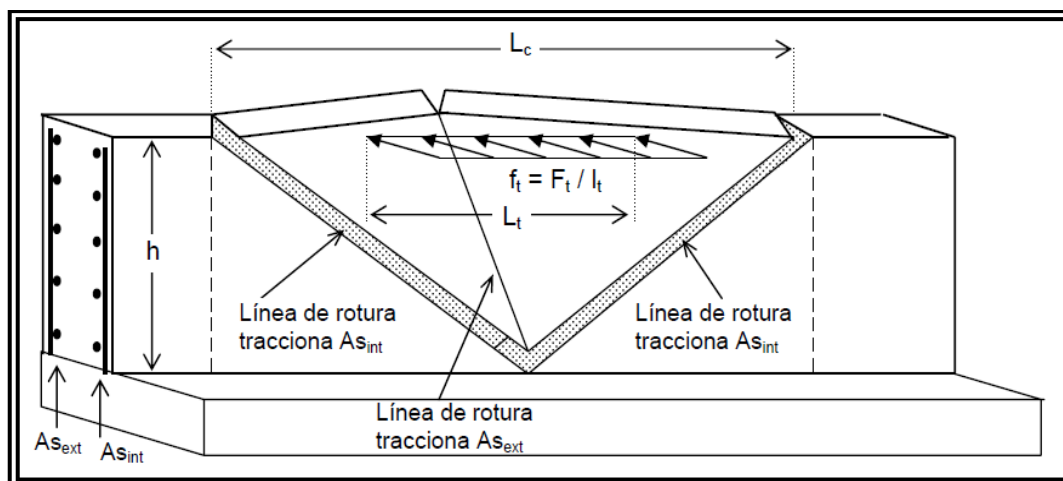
Esquema de líneas de rotura y dimensiones de tramo de baranda.
